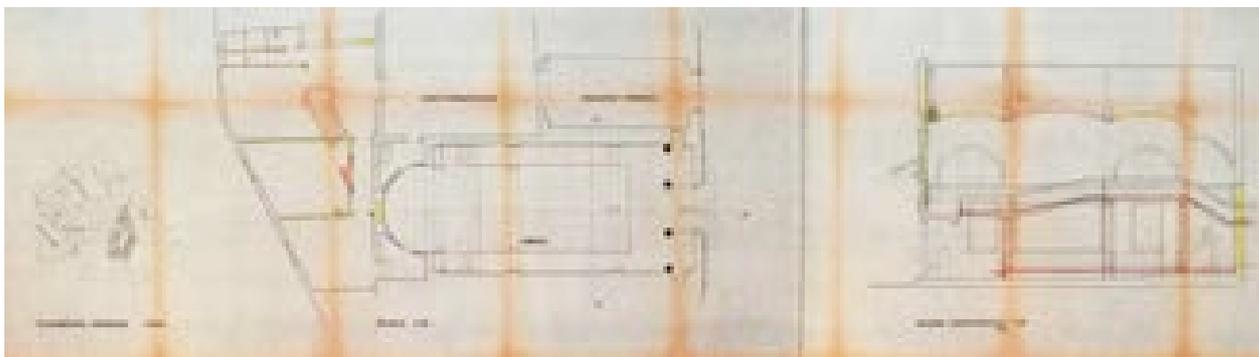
Pianta +0,00 e sezione XX, Giovanni Michelucci\*\* – stato sovrapposto - s.d. (AABS-94.037)
